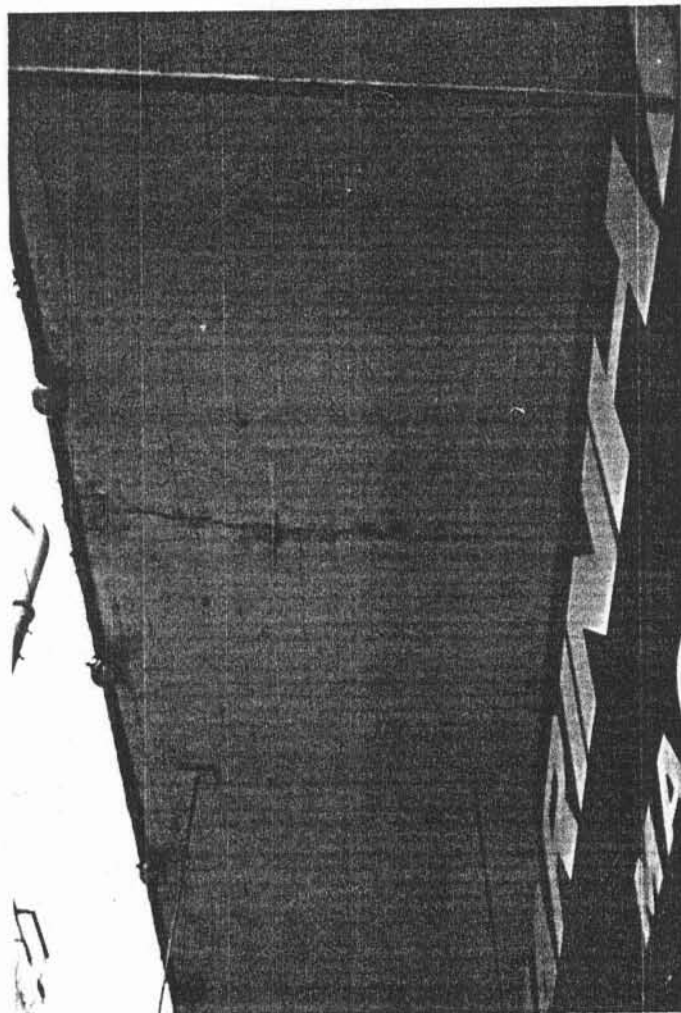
Fissura em marquise originada pela contração térmica
